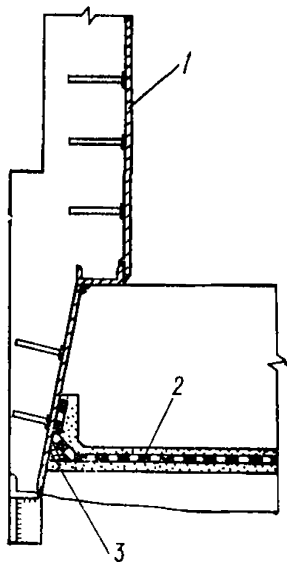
Пример решения сопряжения оклеечной гидроизоляции дна (2) и стальной гидроизоляции стены (1)
